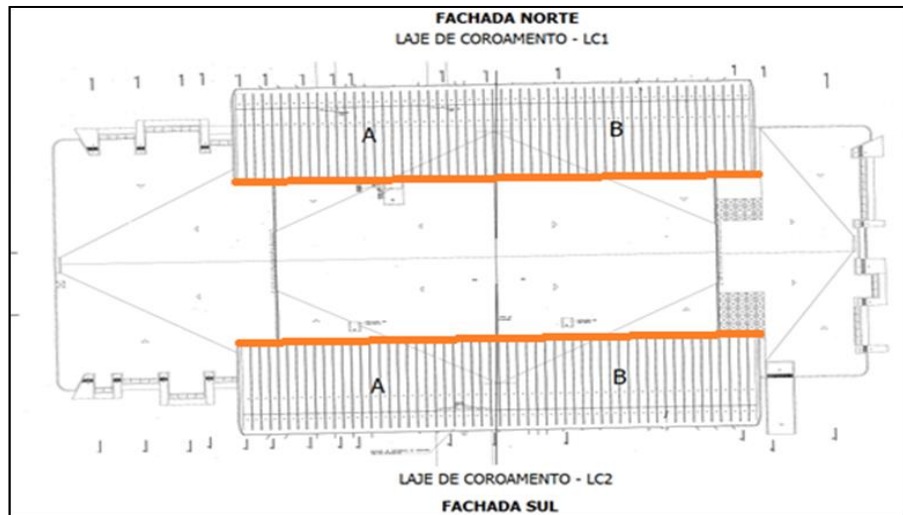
Destaque em planta sob região analisada no estudo de fissuras das lajes de coroamento.
